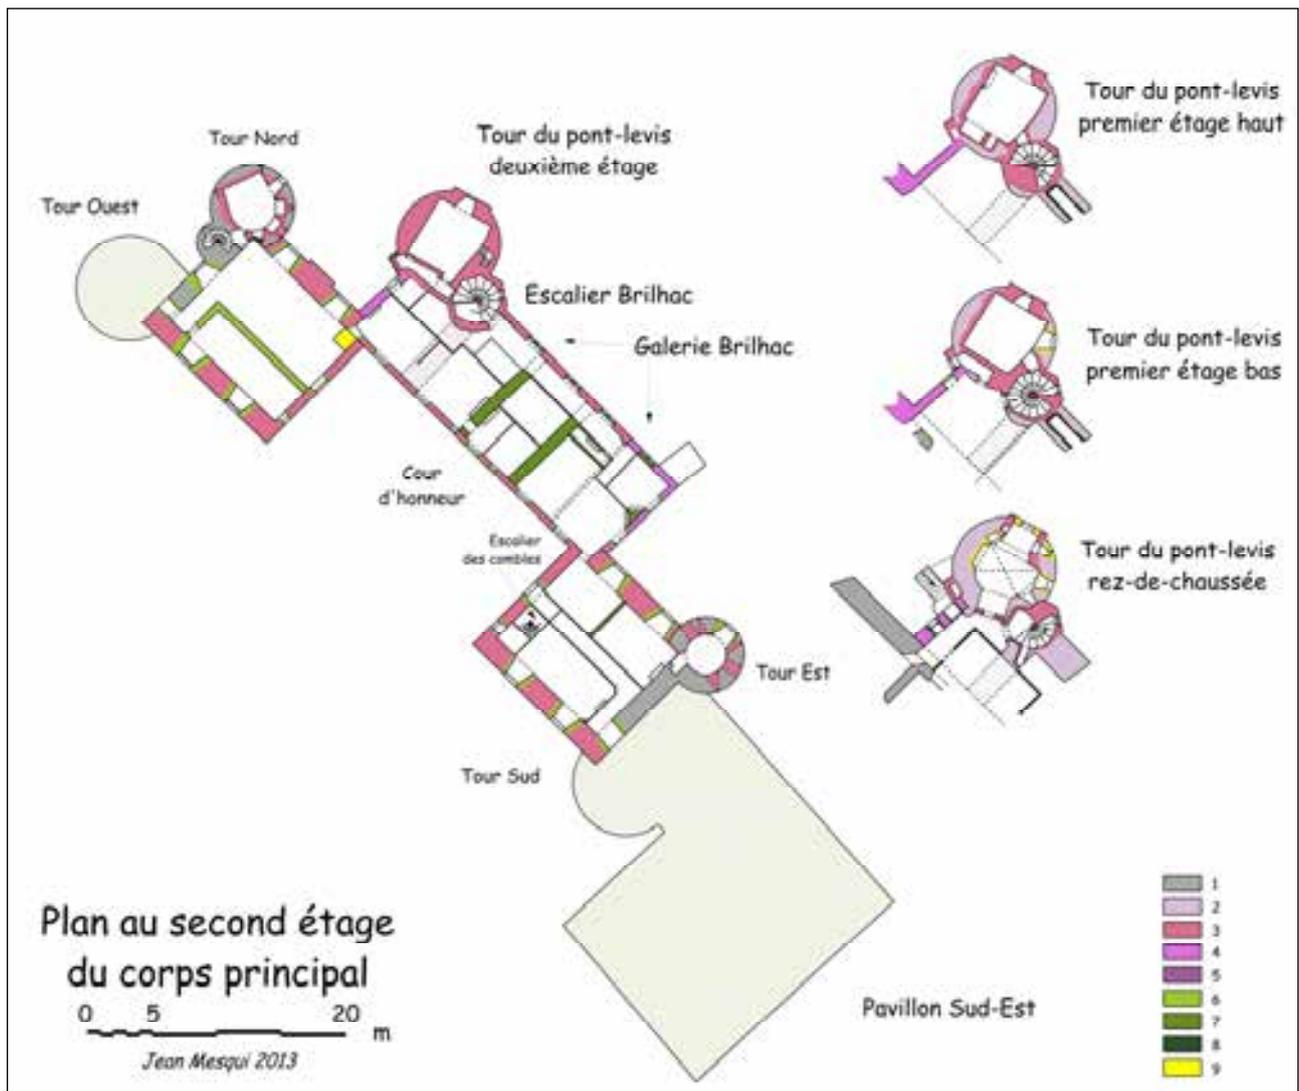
Plan actuel phasé du second étage du logis nord et des pavillons; plans de la tour du pont-levis aux divers niveaux.
